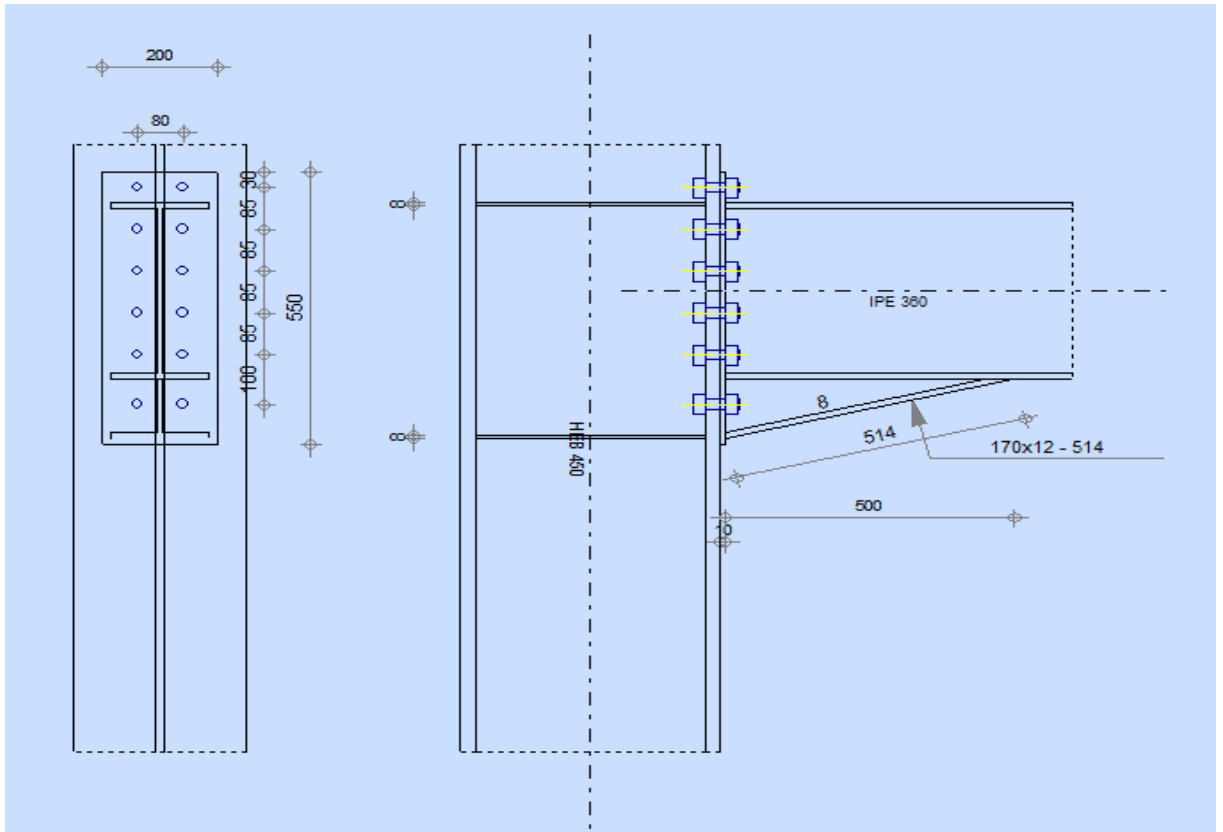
Disposition constructif de l'assemblage poteau - poutre.
